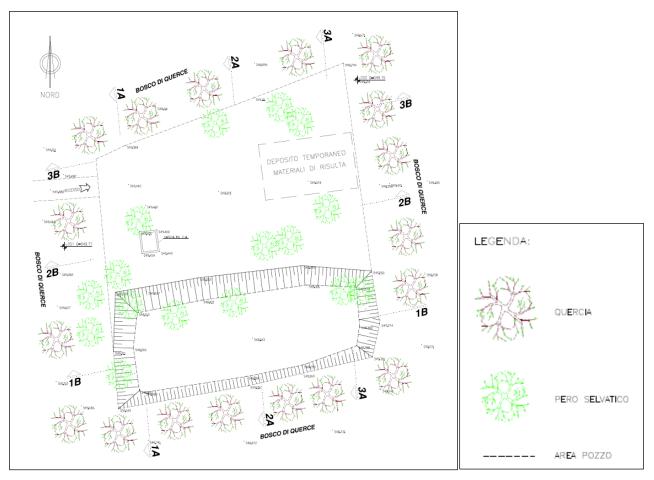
Stralcio Planimetria Stato di Fatto.
